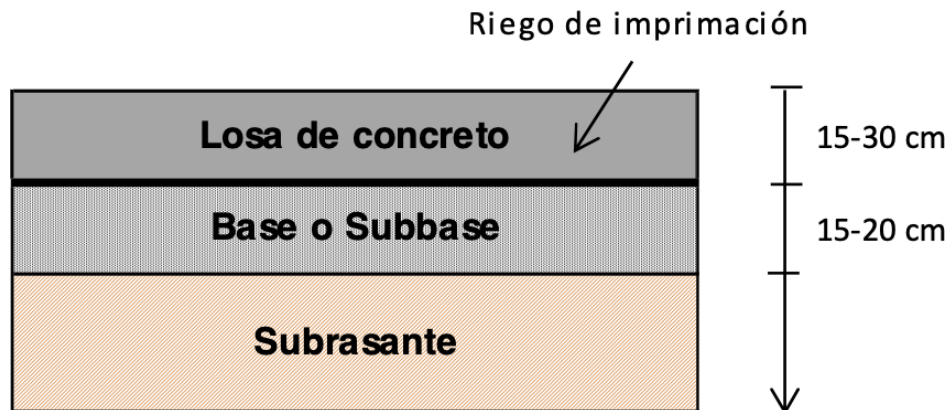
Sección transversal típica de un pavimento rígido. Fuente: Andrade Triviño y Franco Puga (2019).
